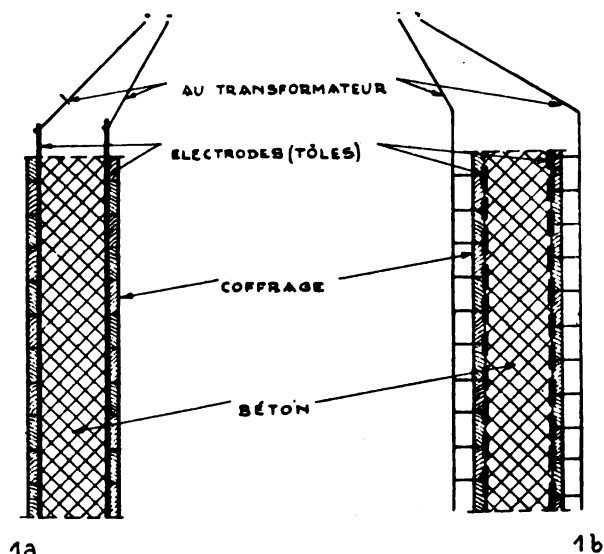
Riscaldamento elettrico di un muro in calcestruzzo non armato, con elettrodi continui (sinistra) e discontinui (destra).
